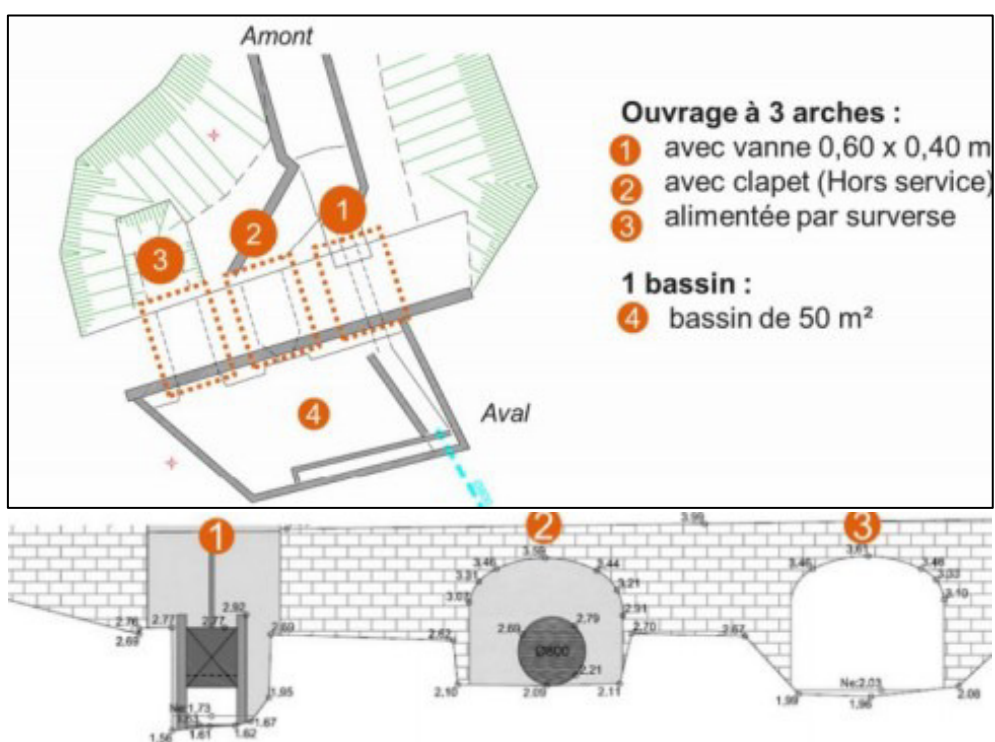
Vues en plan et en coupe de l'OH1 (source : Arcadis, 2018)
